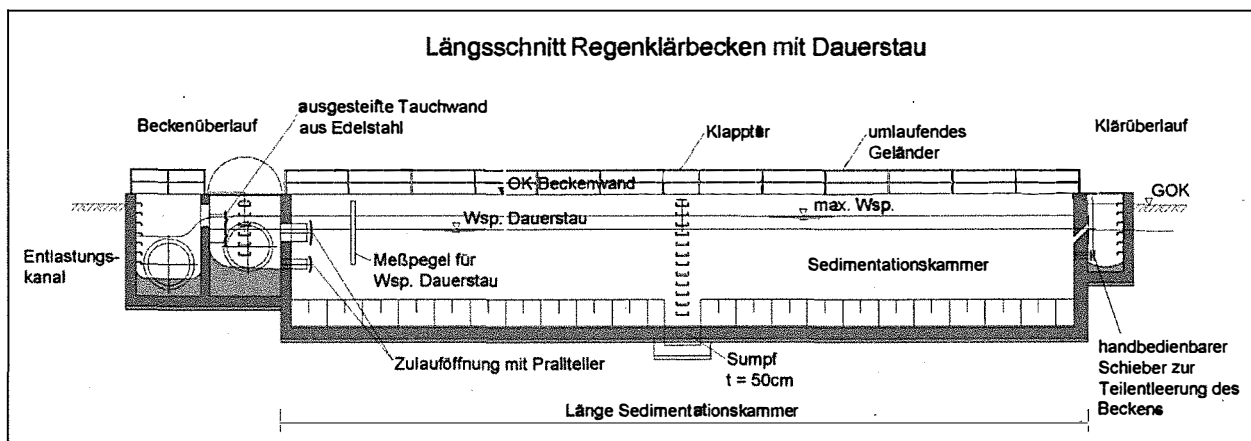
Systemlängsschnitt Regenklärbecken mit Dauerstau
